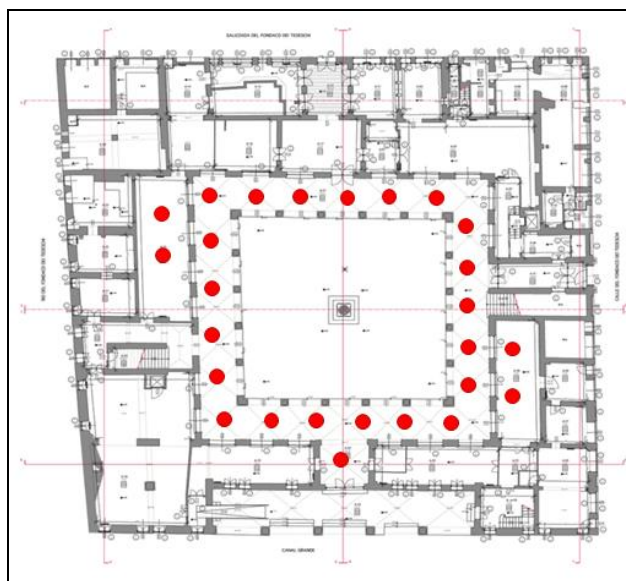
Distribuzione planimetrica delle sonde geotermiche realizzate negli spazi ricavati nel porticato del cortile interno di un edificio storico del 1300, affacciato sul Canal Grande.
